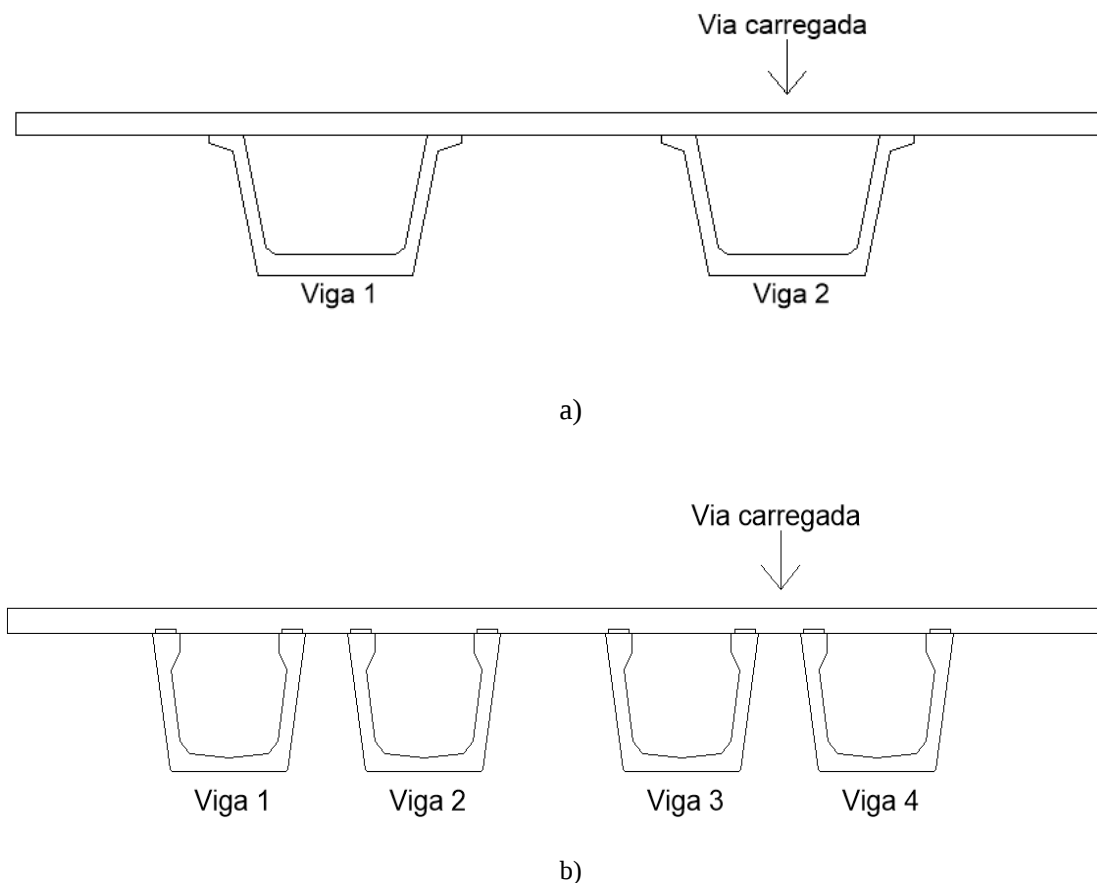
Identificação das vigas de cada secção: a) viga artesã, b) viga W-13.
